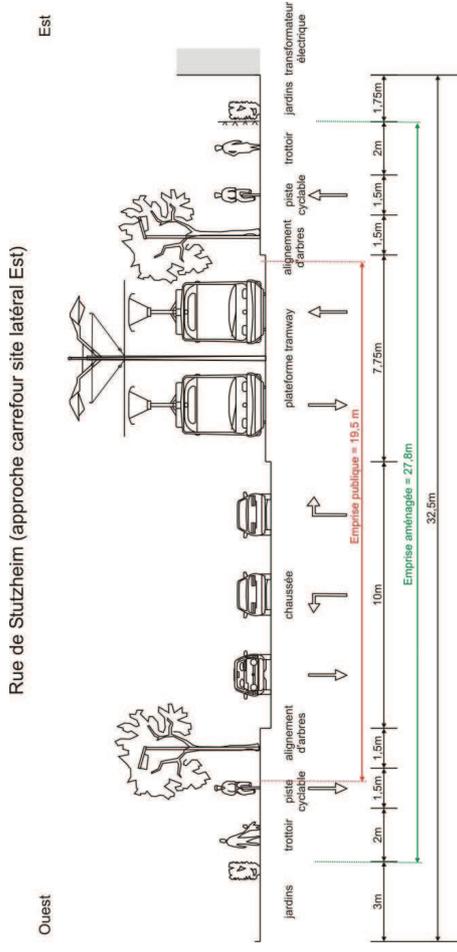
Situation projetée (coupe 6) sur la rue de Stutzheim (site latéral Est)
